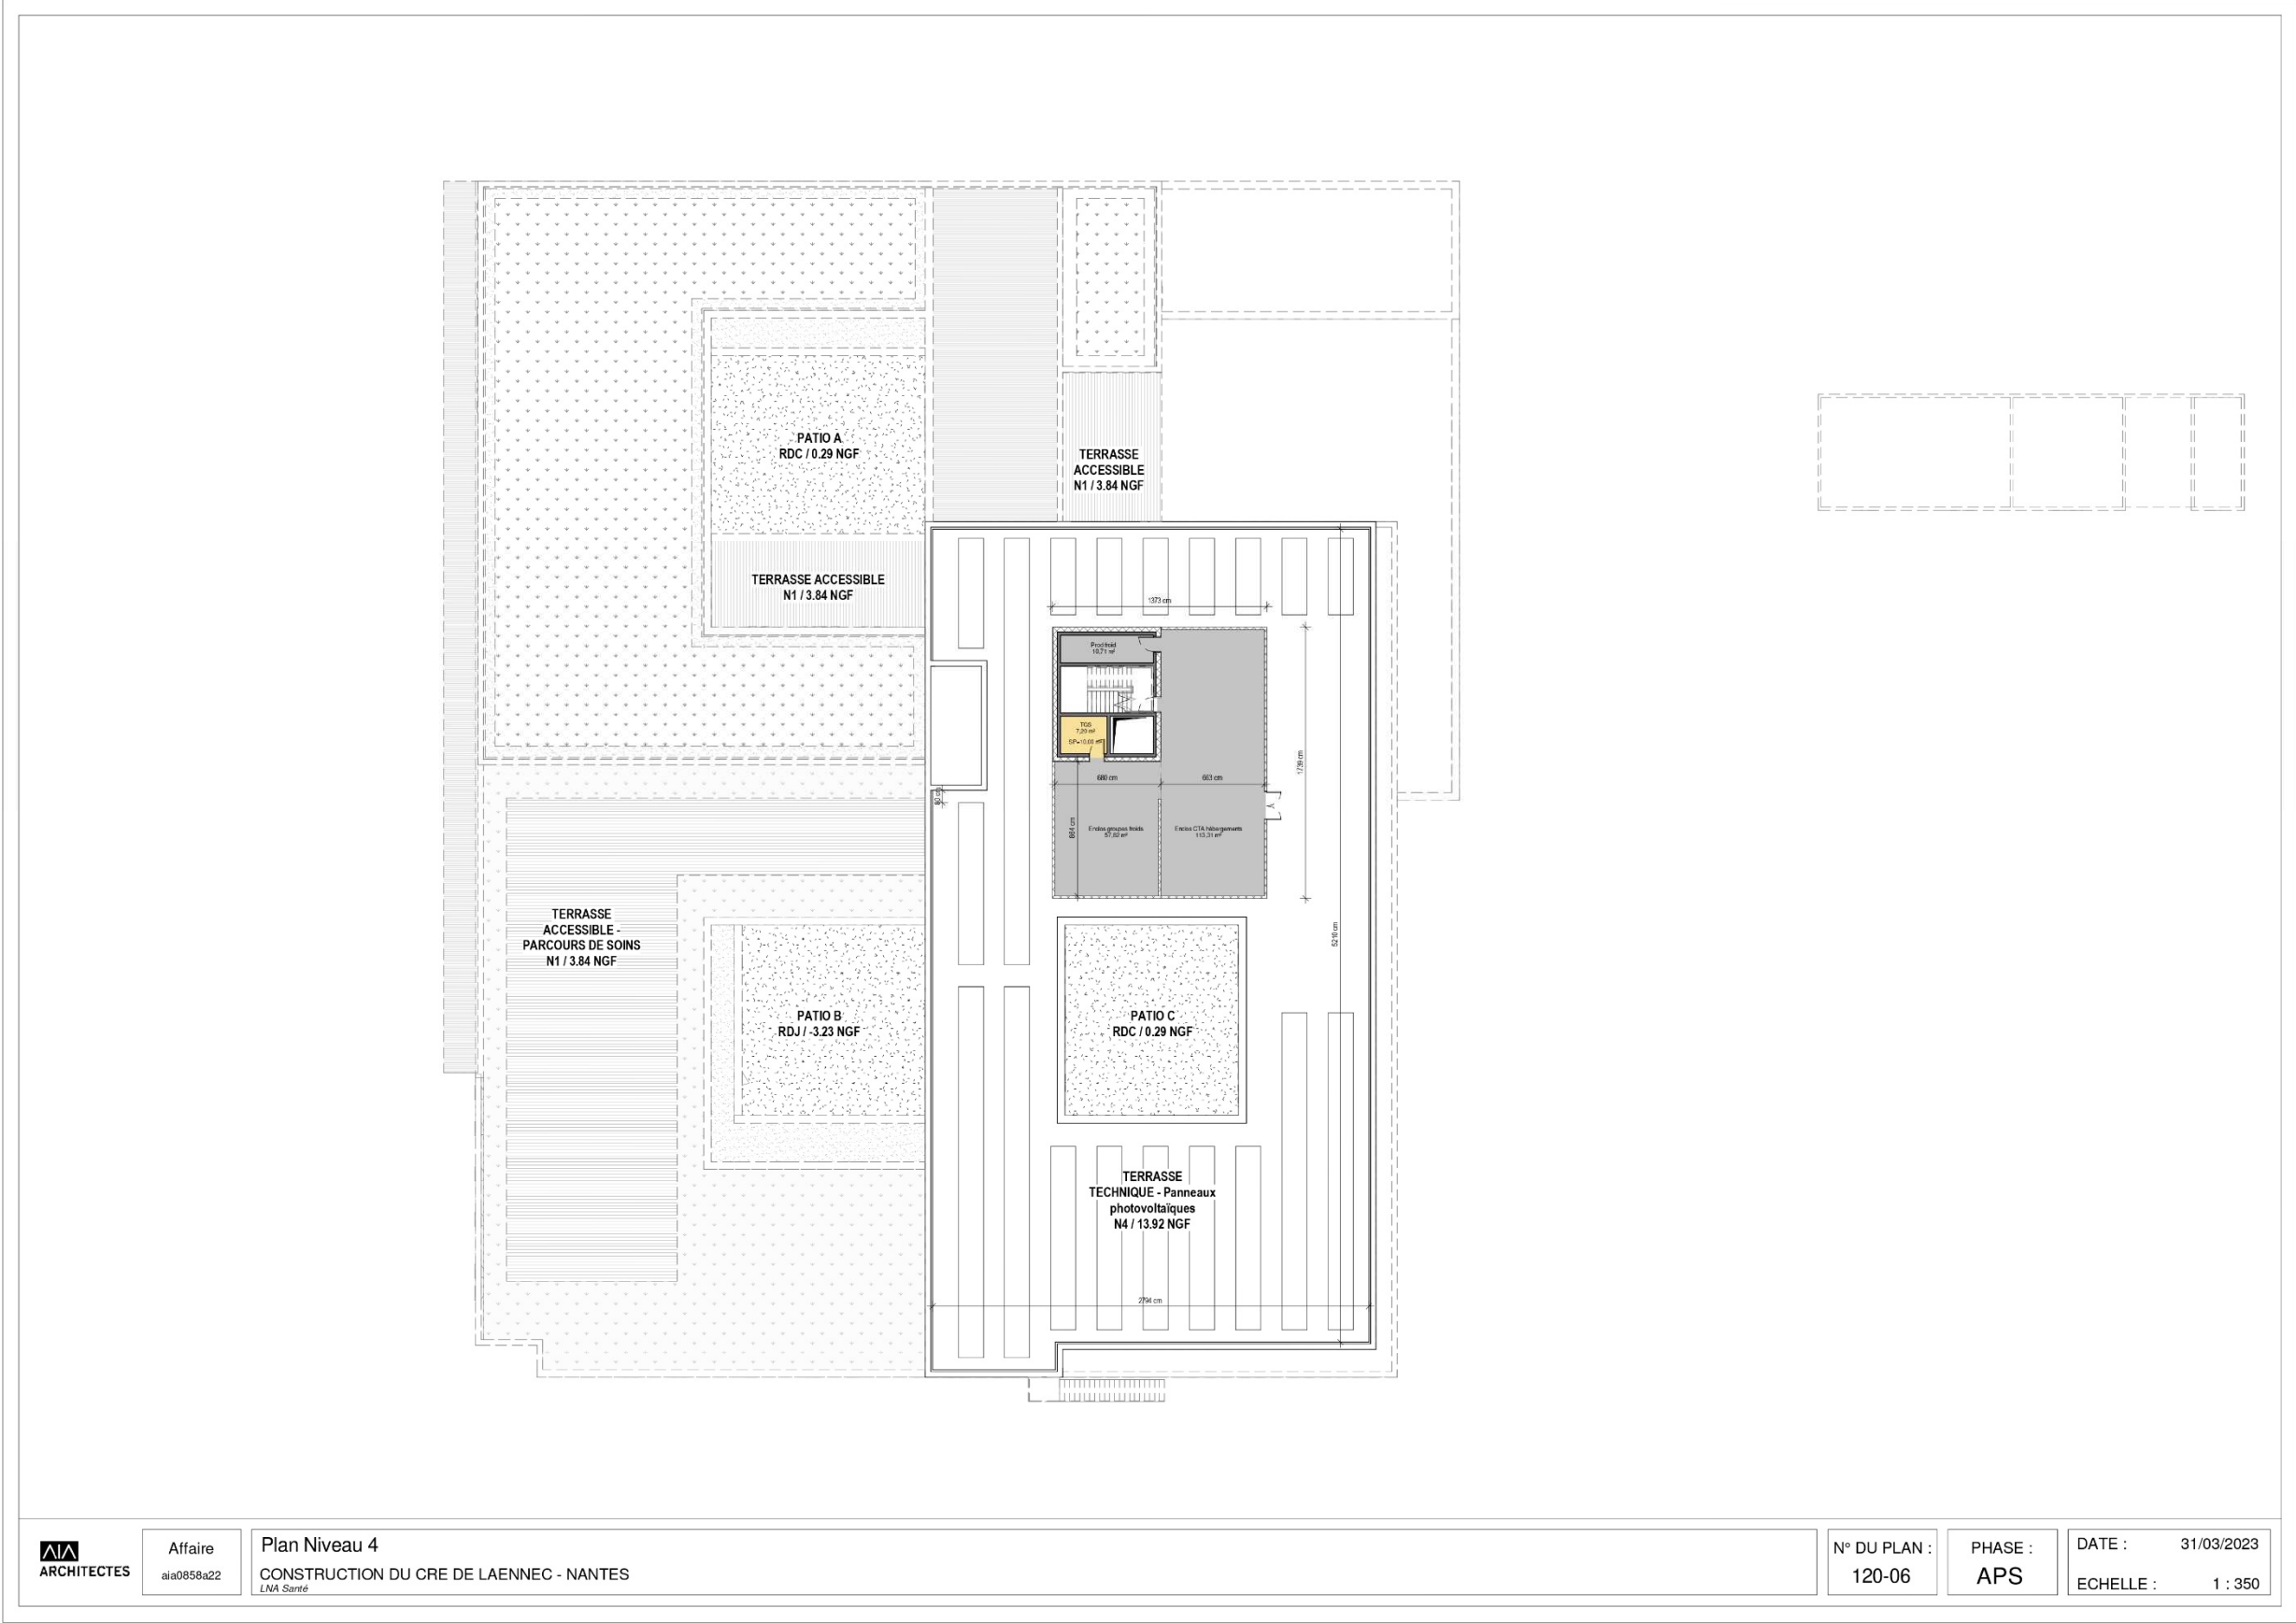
Plan de Niveau 4 (source: AIA Architectes, 31/03/2023)
